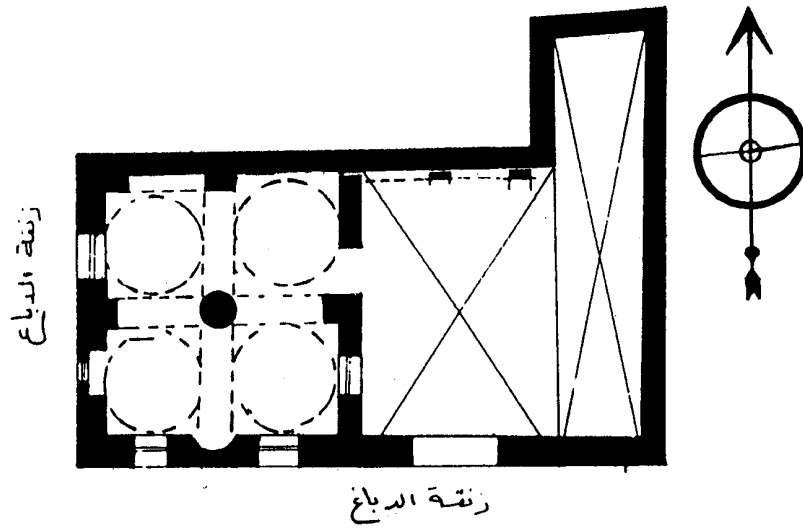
مسقط أفقي للمشهد القبلي بأسوان
